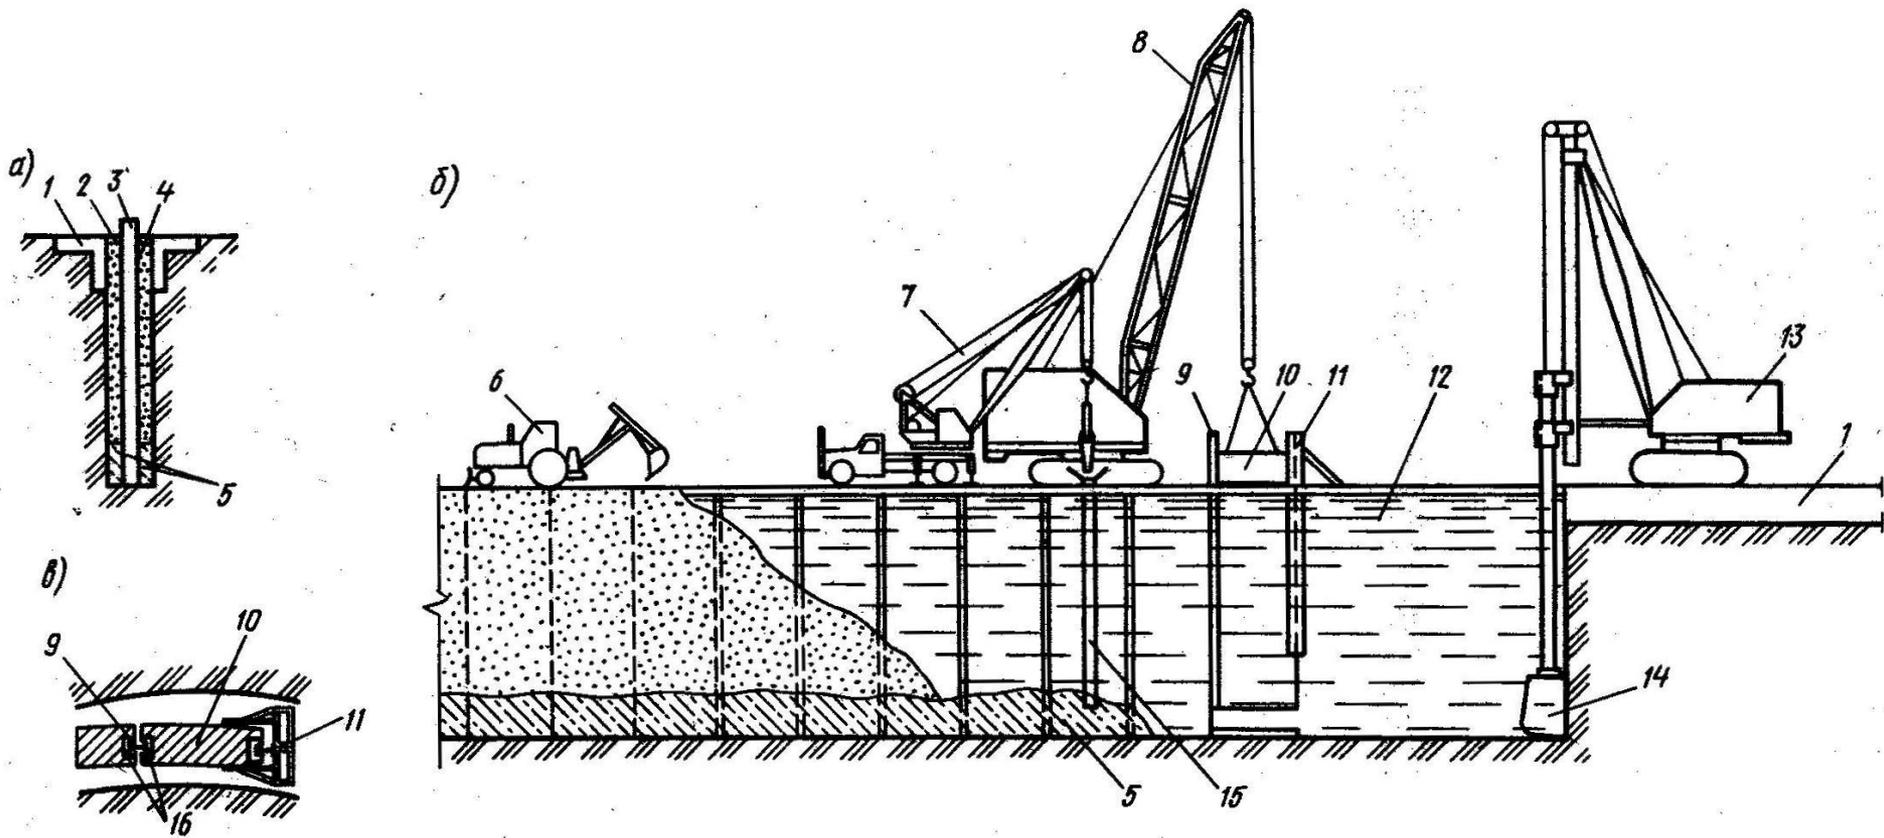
Схема расположения механизмов при монтаже сборных элементов методом «стена в грунте» (схема комплексной механизации):
